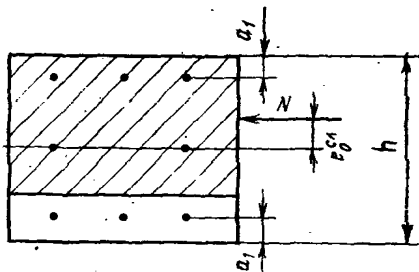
Сечение железобетонной сваи для расчета на внецентренное сжатие
